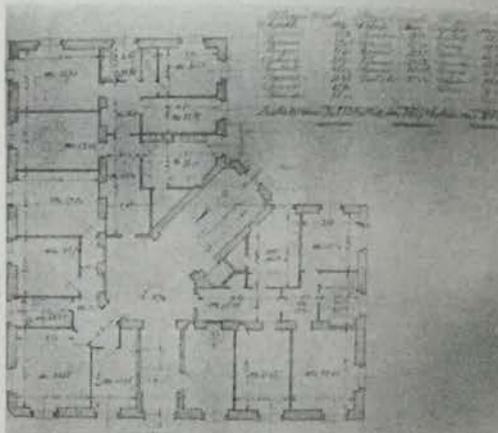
a - Casa Carpano: pianta del piano rialzato
